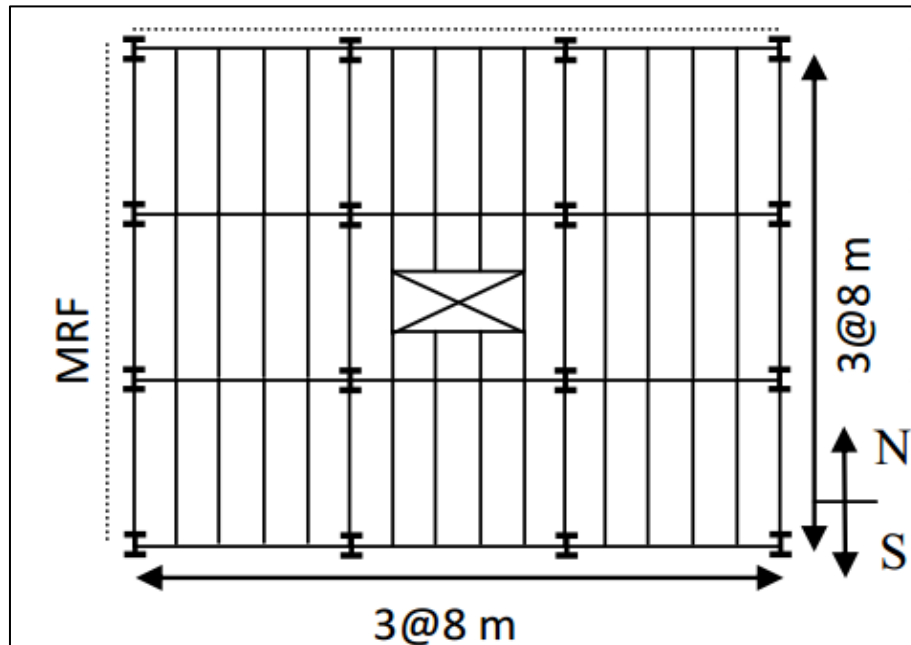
Vista en planta del edificio utilizado para el Estudio.
